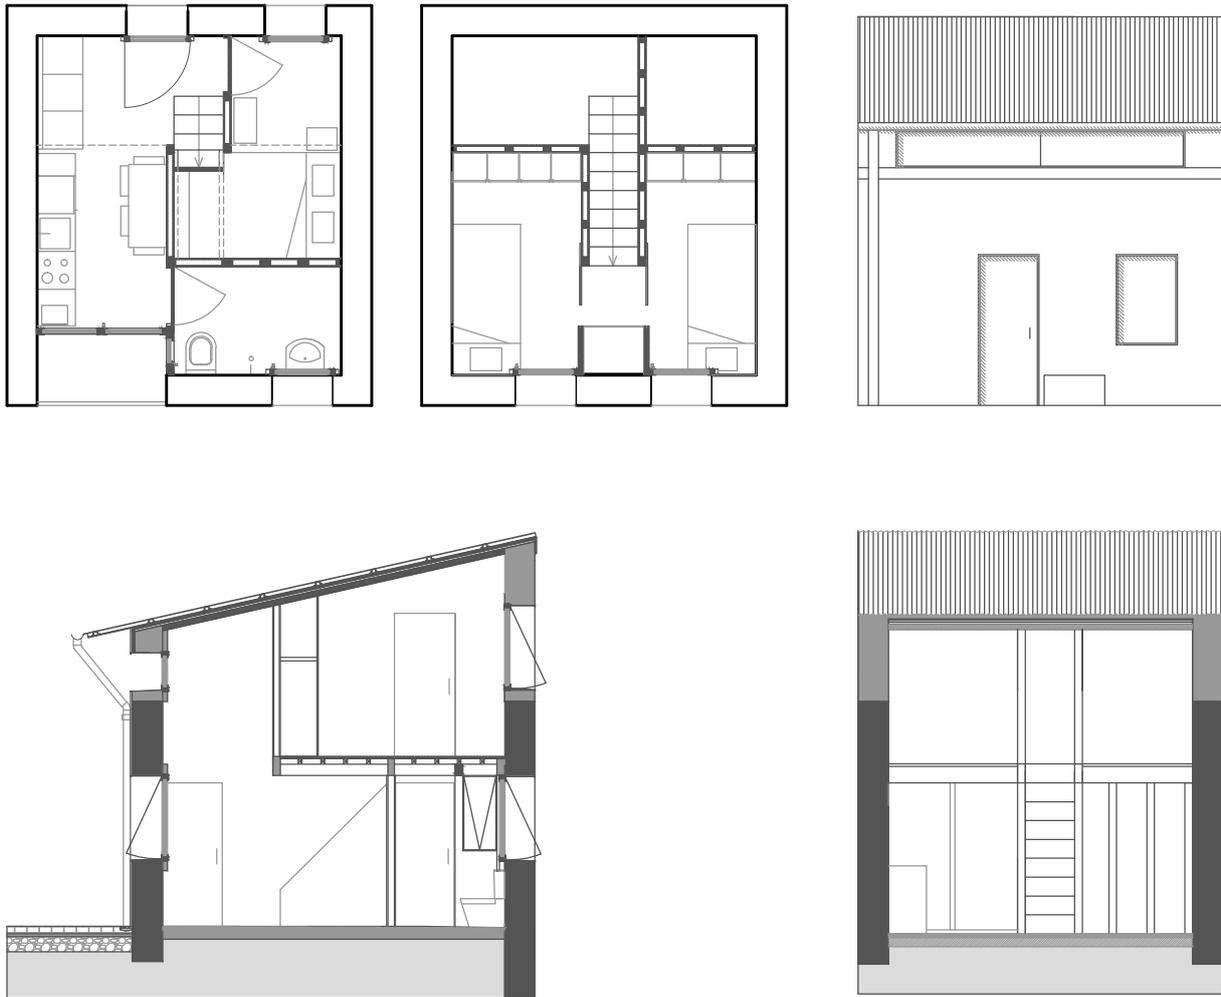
Plantas, Secções e Alçado Tipologia B esc. 1:100
